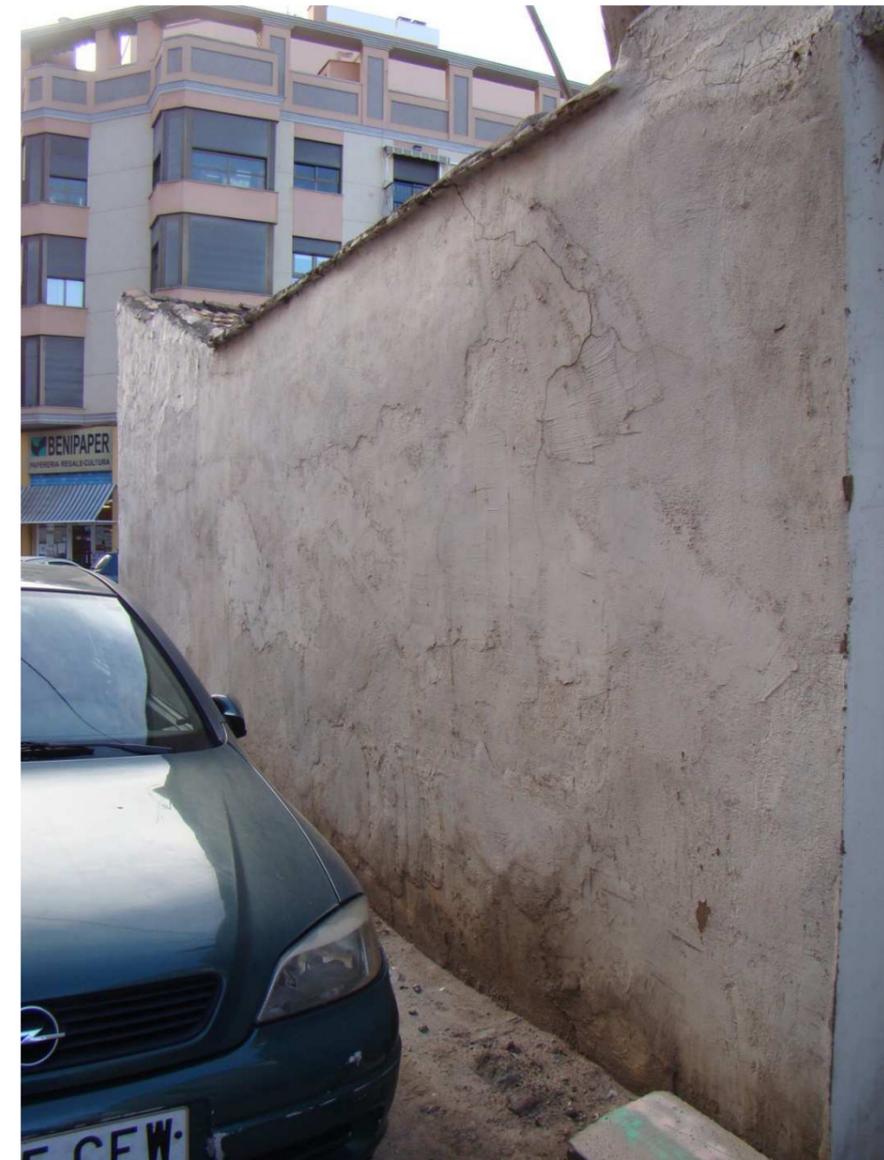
Fisuras en fachada sur (autor propio)
